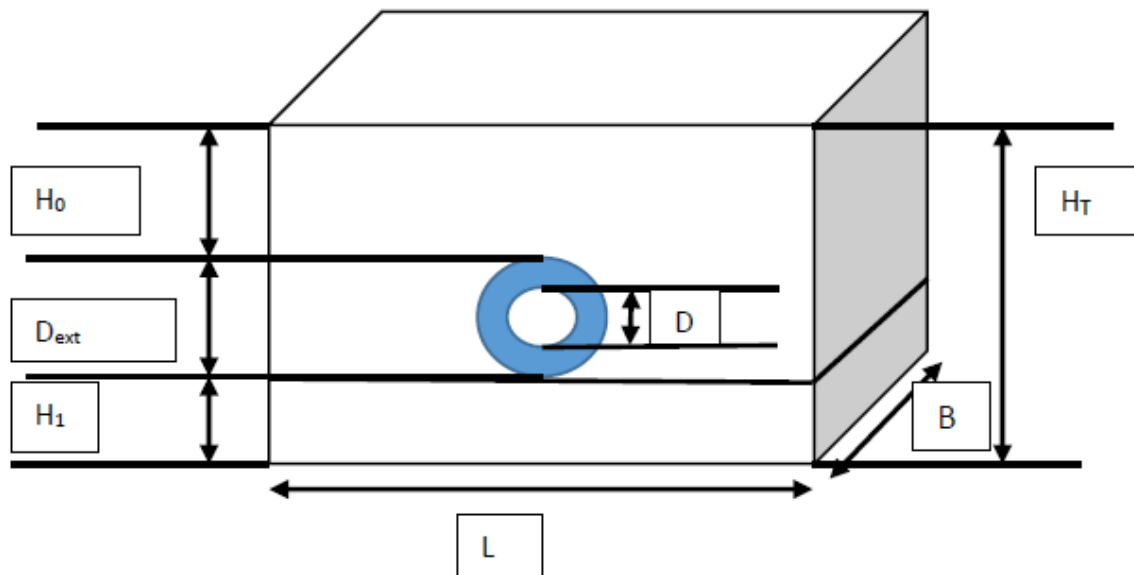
Coupe en perspective d'une fouille avec conduite.
